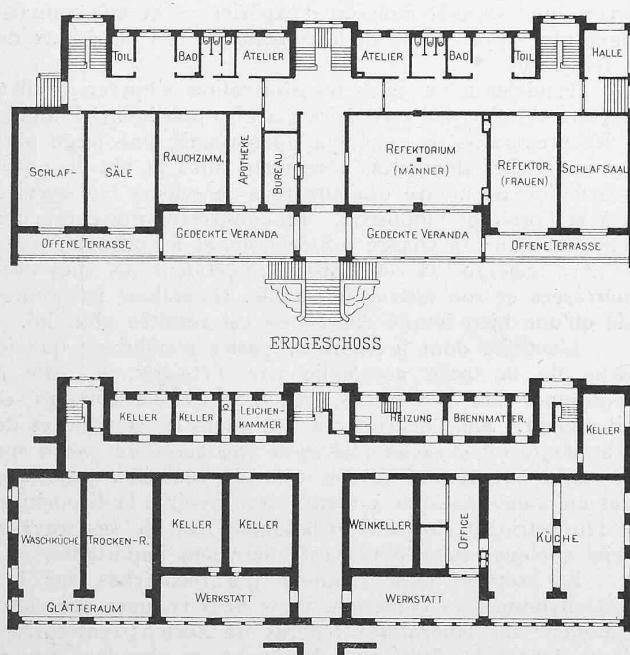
und 4. Grundrisse vom Keller- und Erdgeschoss.
